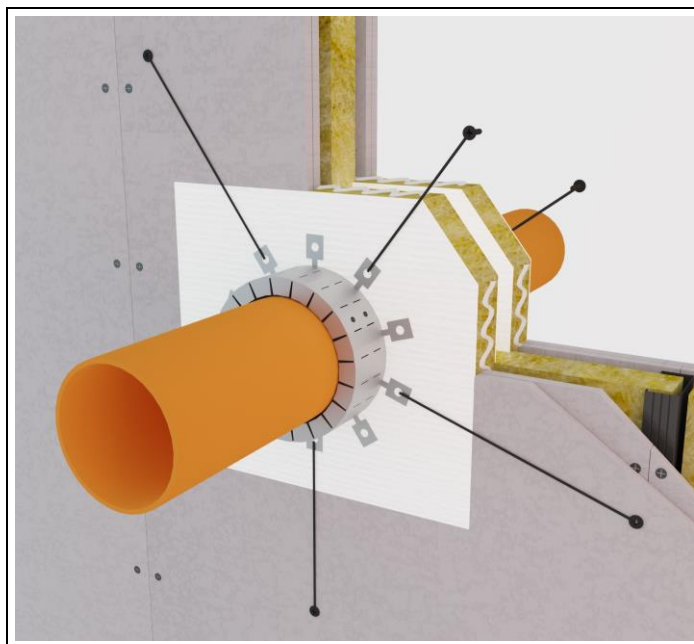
Esempio di un KF-Multicollar fissato con cavi d'acciaio ad una parete.
